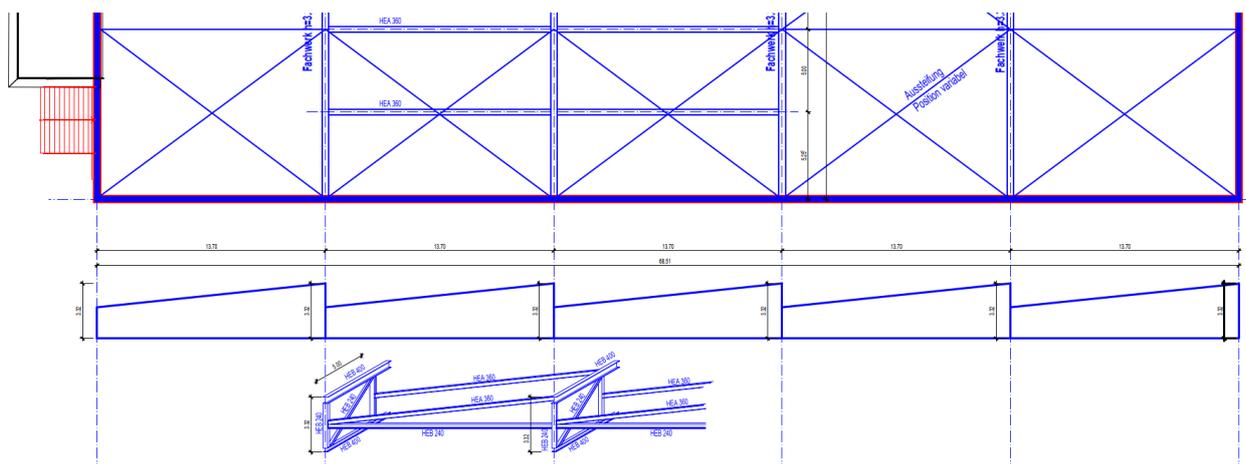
Konzept Shedd-Dachkonstruktion, Stahl
